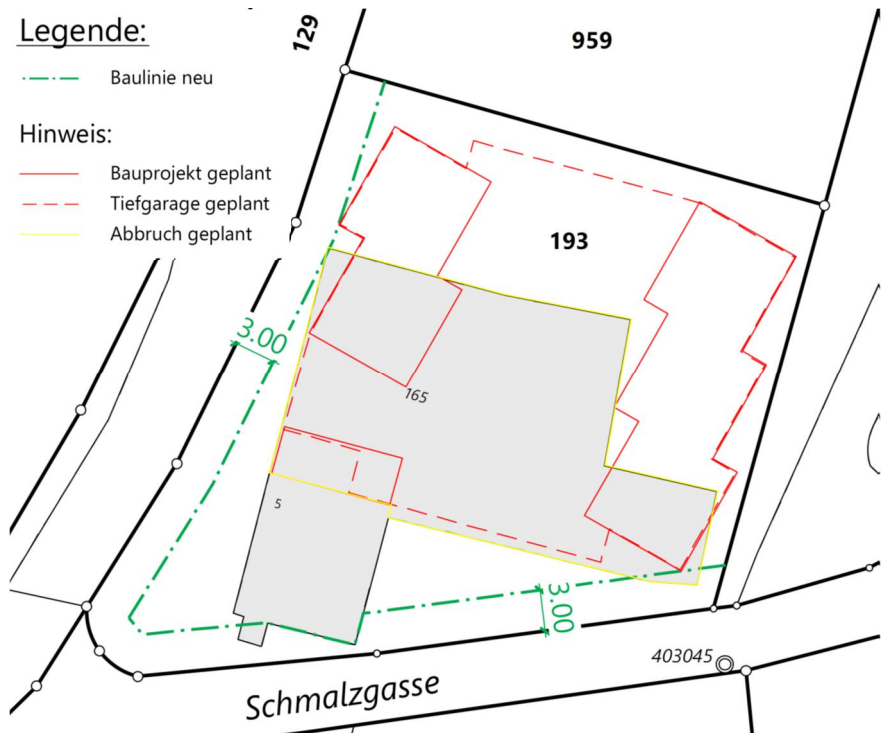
Ausschnitt Baulinienplan Schmalzgasse
